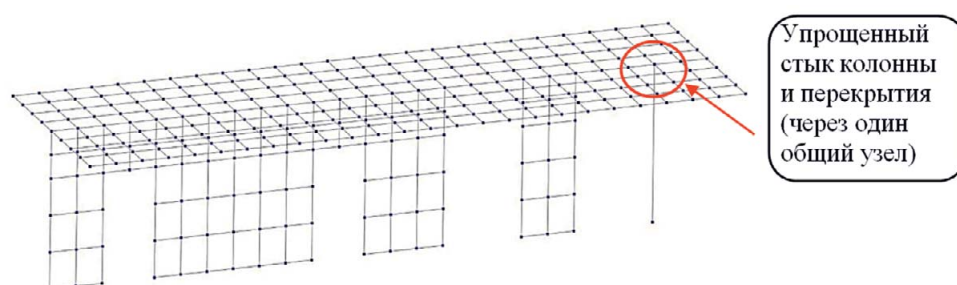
Упрощенная модель стыка вертикальных несущих конструкций и конструкций перекрытия типового этажа
